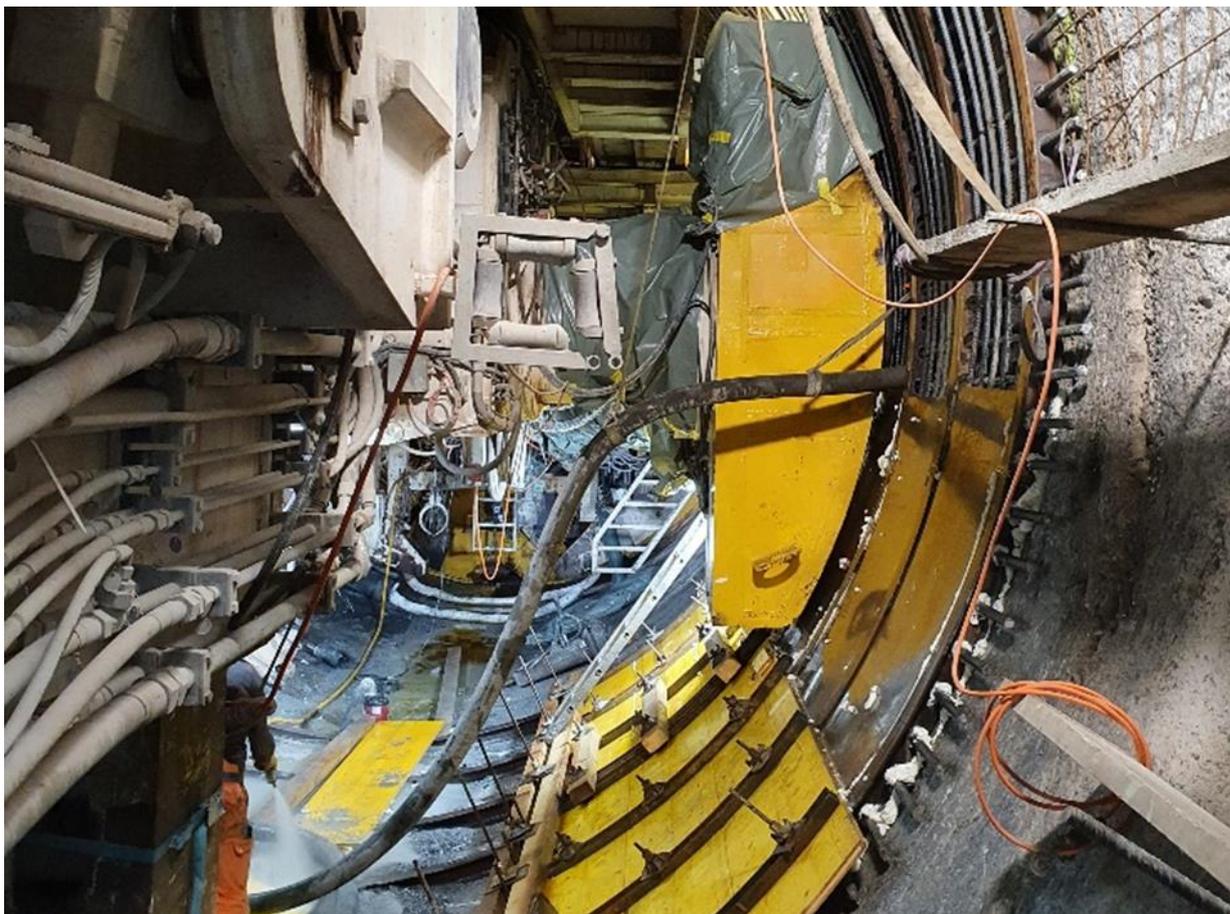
Auflage betonieren für den notwendigen Halt der Gripperwiderlager.
